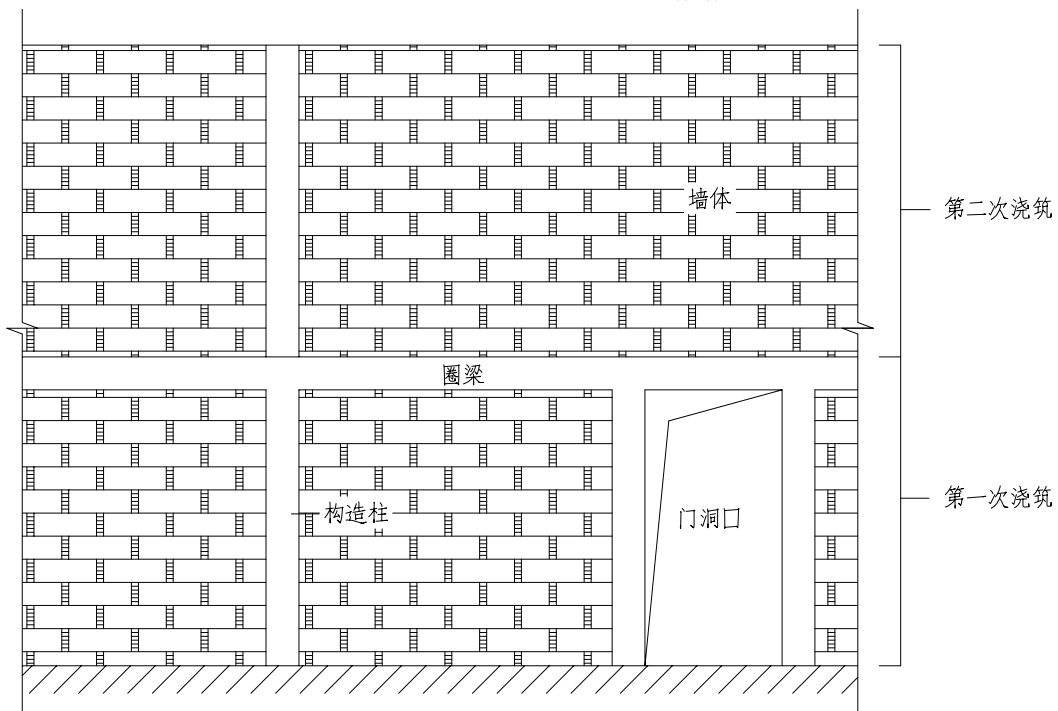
圈梁、构造柱及拉结筋的施工顺序
